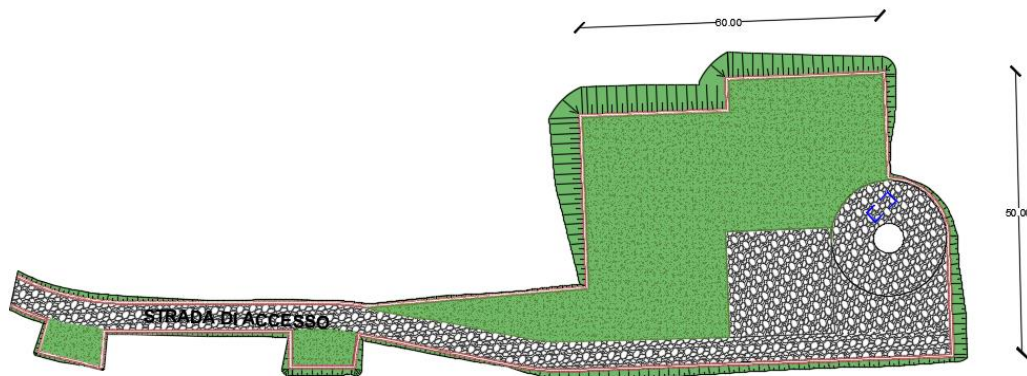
Planimetria piazzola tipo in fase di esercizio
